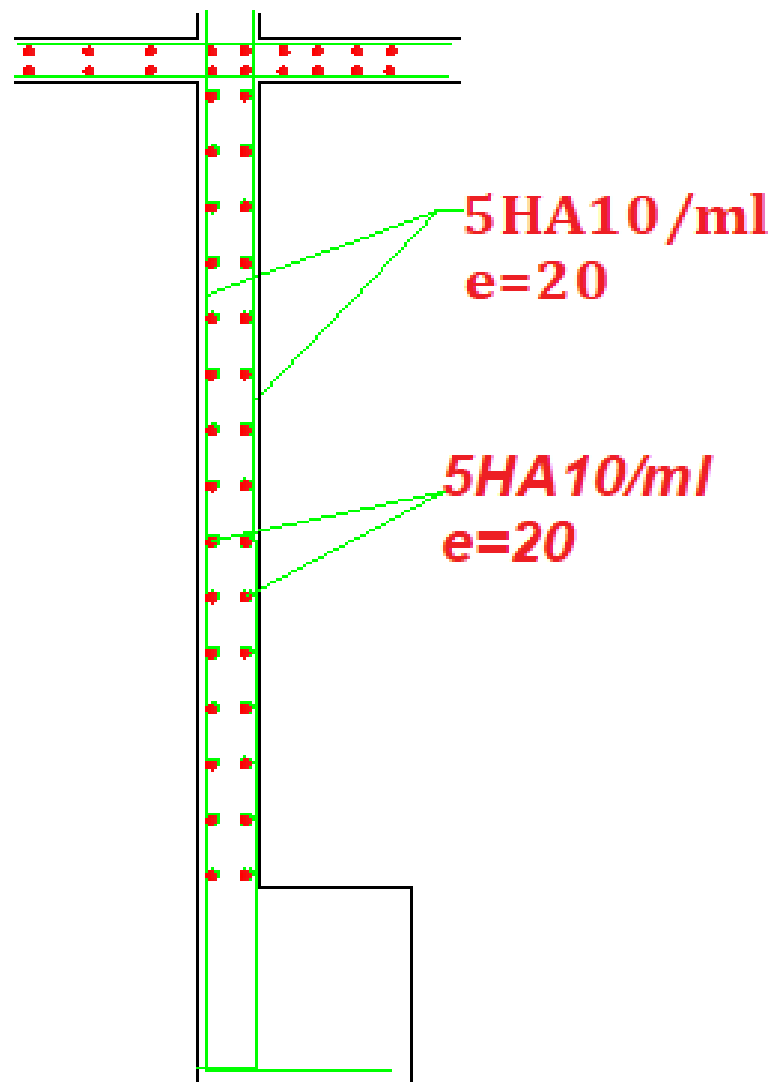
Ferrailage de voile périphérique coupe -AA-
